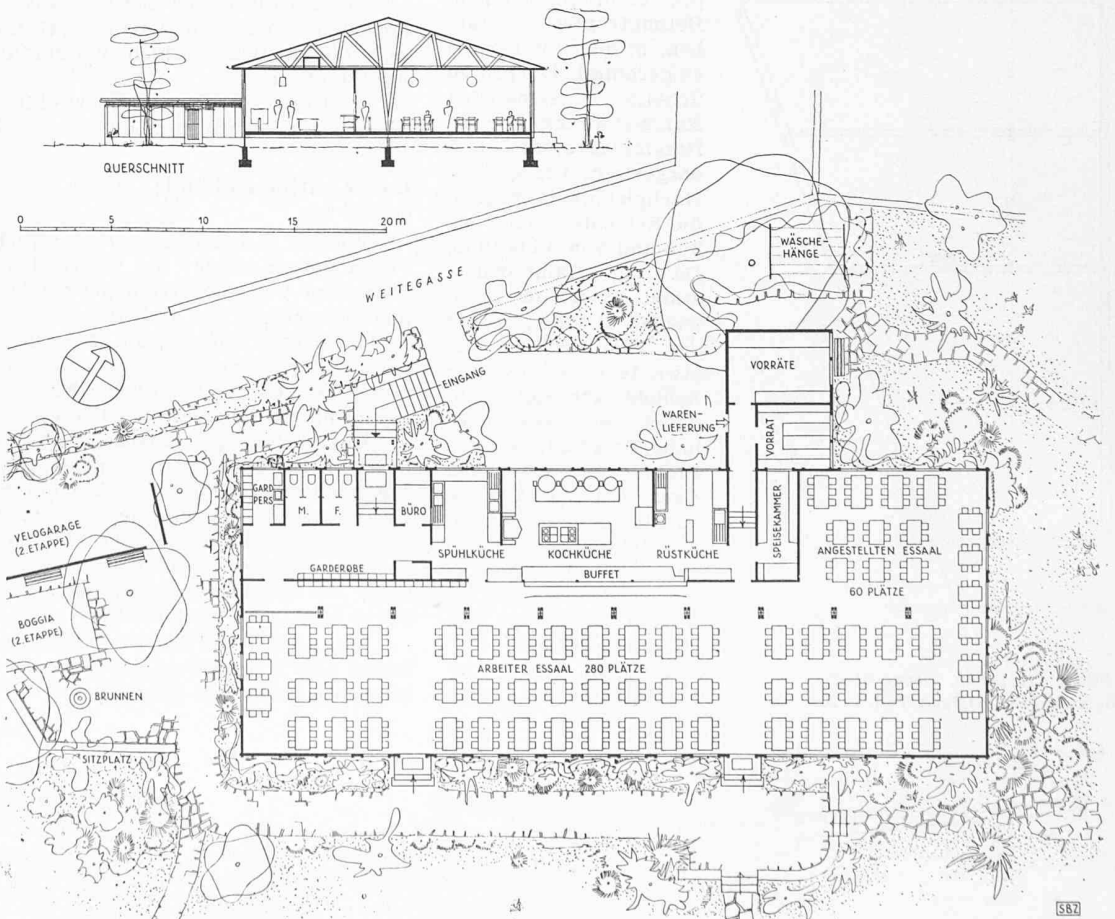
Kantine Saurer in Arbon, Grundriss und Schnitt 1 : 400. Arch. G. P. DUBOIS & J. ESCHENMOSER
